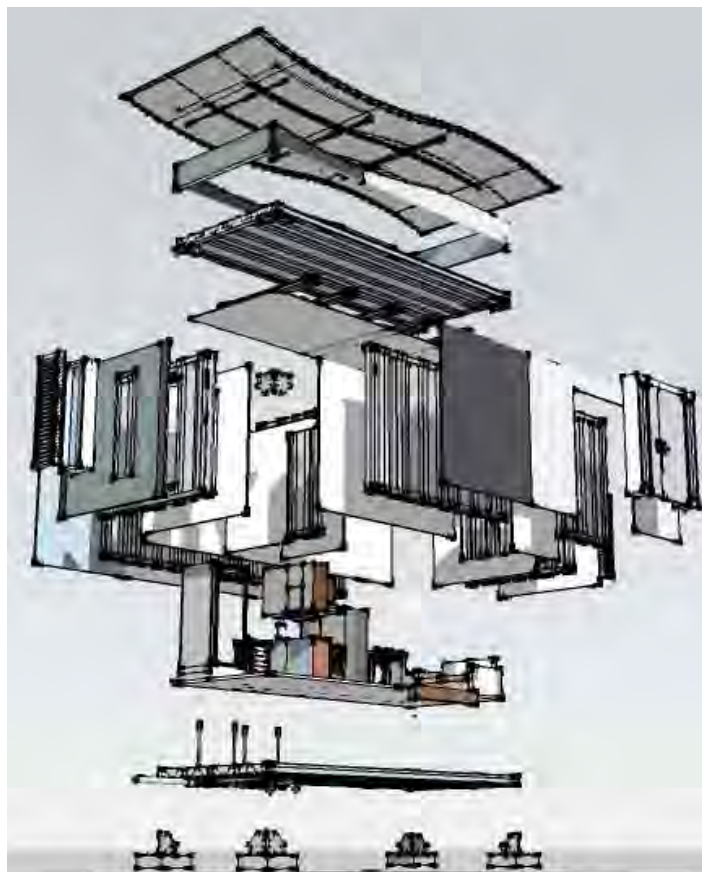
Módulo A deconstruido. Fuente: Elaboración propia 2010.
